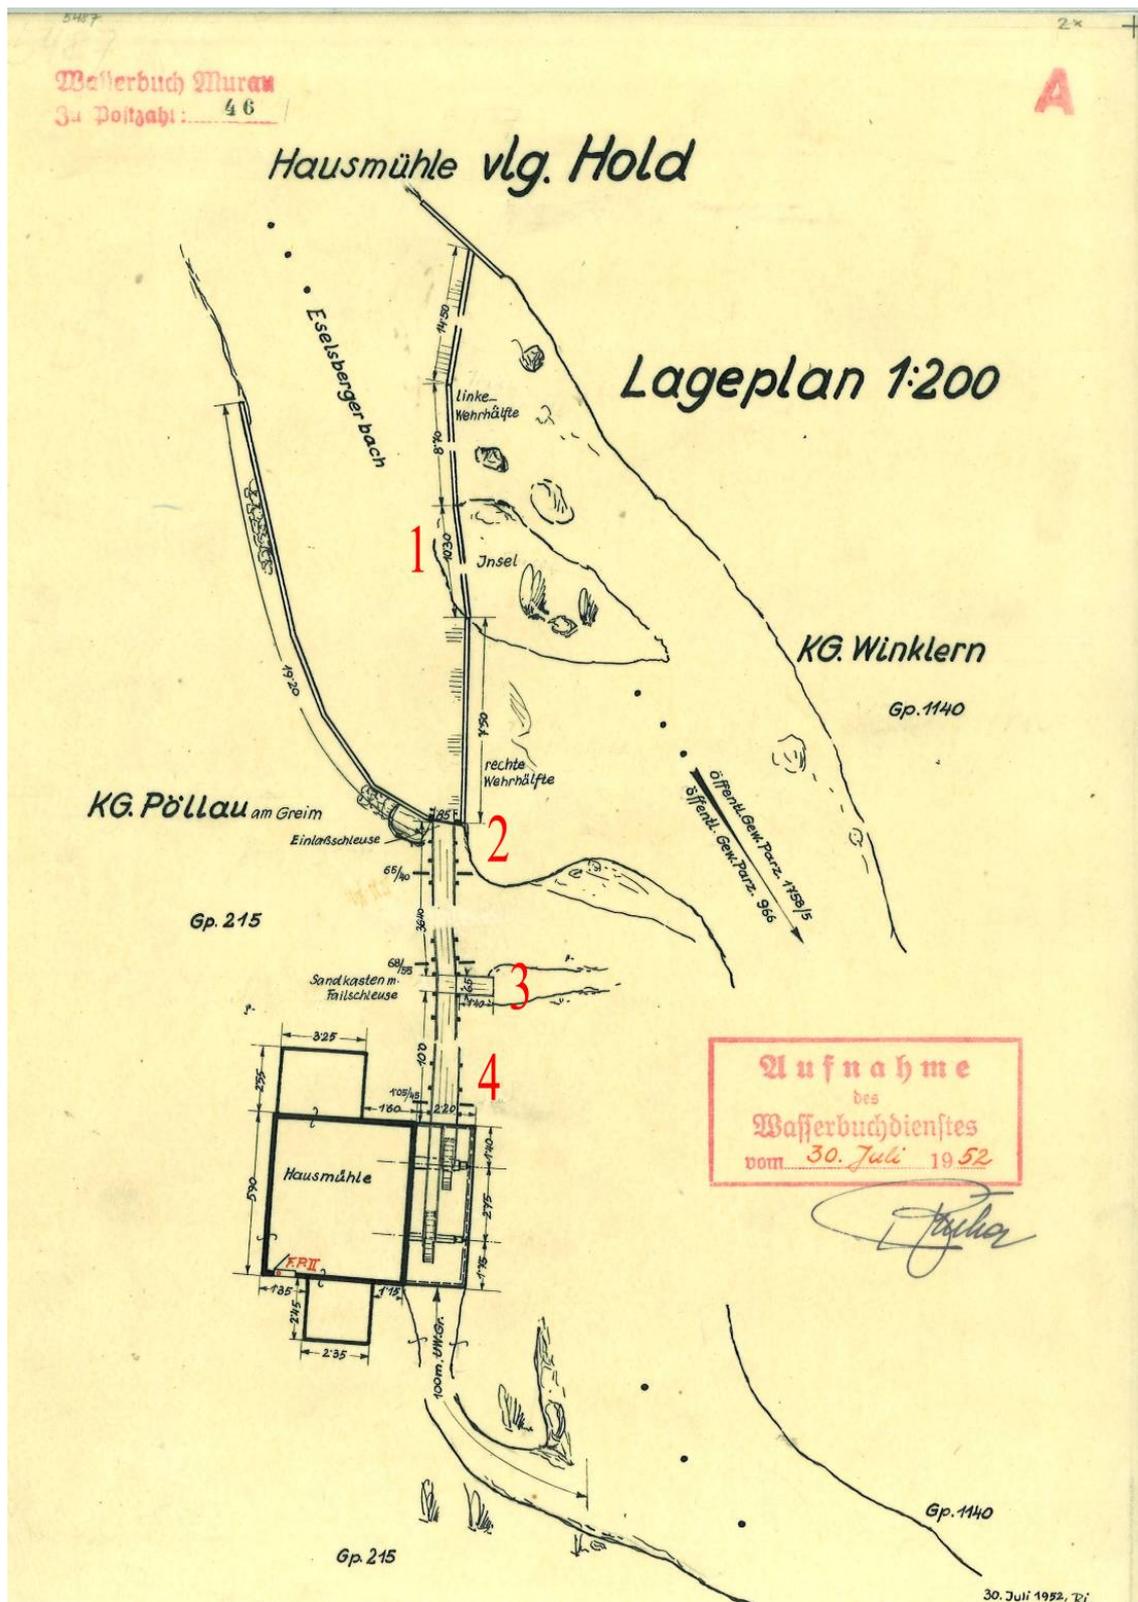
Darstellung der Wasserzuleitung mit den einzelnen Komponenten wie Wehranlage (1), Wasser-Einlaufschleuse (2), Sandfang mit Fallschleuse (3), Zuleitung zum Wasserrad mit z.B. schwenkbarem Endstück (4)
